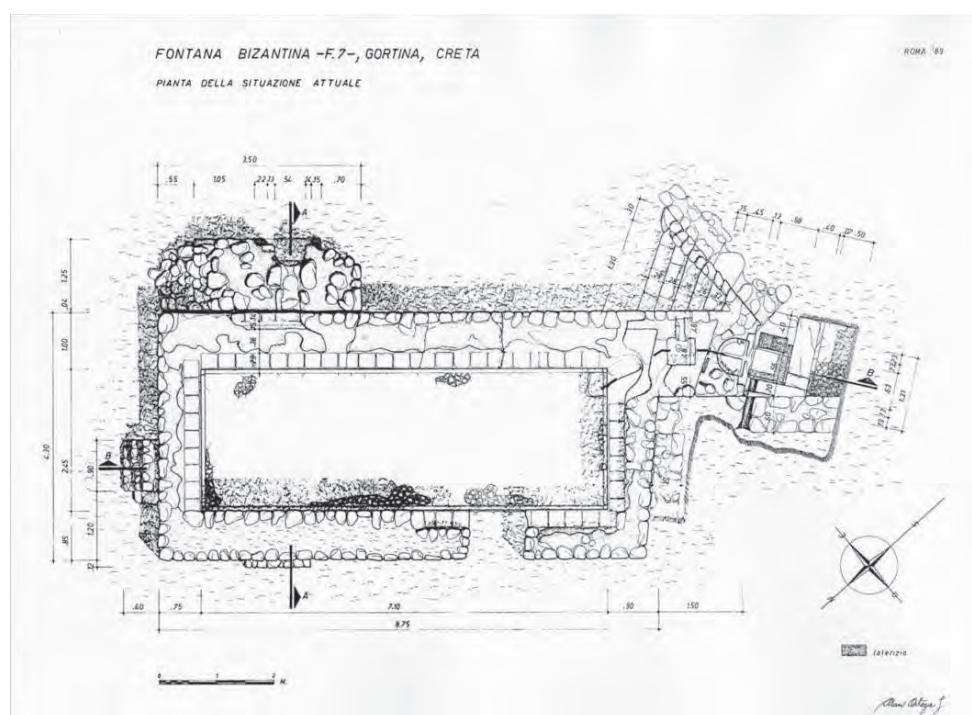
Planimetria della cisterna/fontana nr. 88 (Archivio SAIA).
